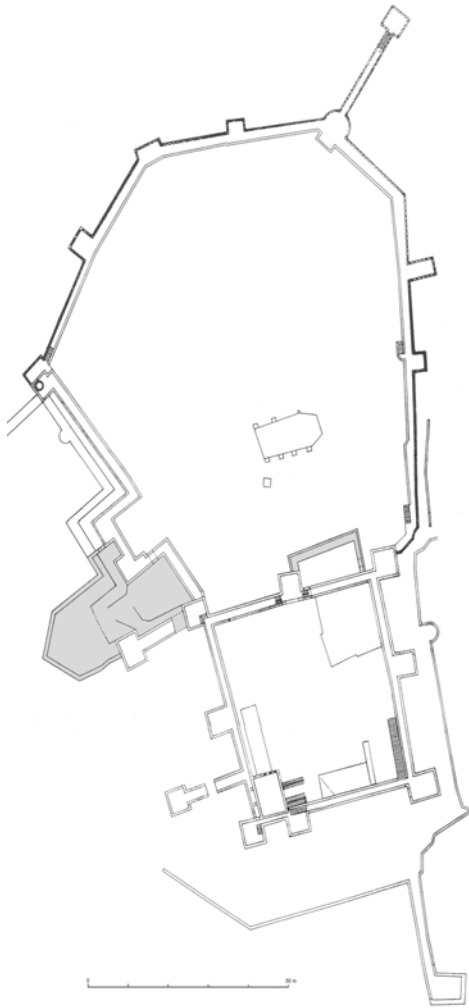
Planta del castillo de Trujillo con indicación de la situación del baluarte y del antemuro de la poterna del primer recinto (Lafuente y Zozaya 1999, figura 1, con retoques del autor)
